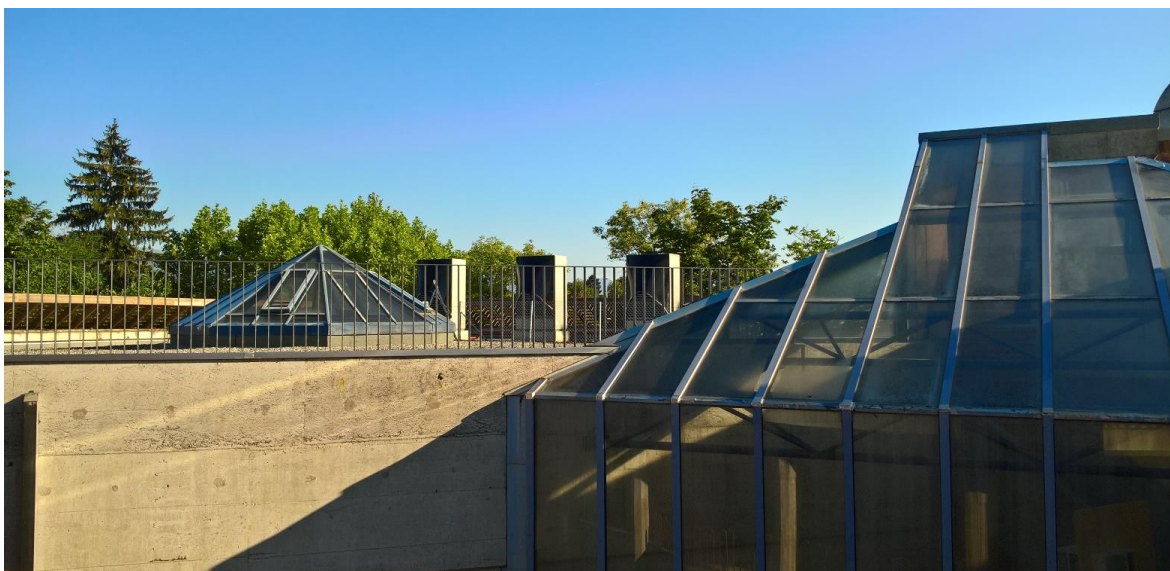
Dachaufsicht mit den drei Wärmepumpen. Quelle: SIG-éco21
